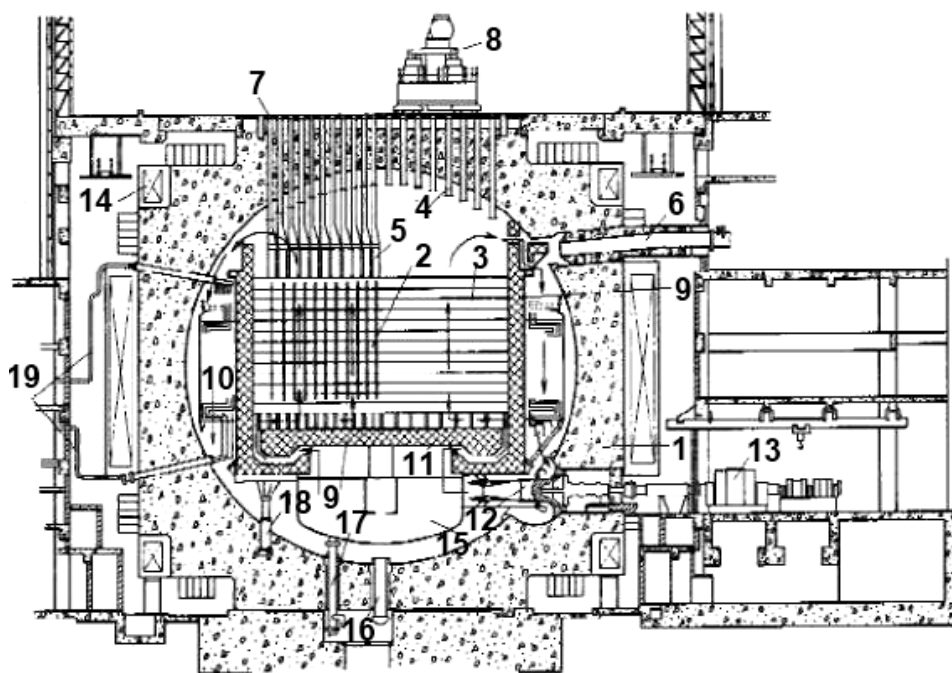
Поперечное сечение реактора «Магnox»: 1 – корпус реактора; 2 – ТВЭЛы; 3 – графитовый замедлитель; 4 – загрузочные каналы; 5 – система направляющих труб; 6 – каналы с предохранительными клапанами; 7 – крышка; 8 – загрузочная машина; 9 – нейтронная защита; 10 – парогенератор; 11 – радиальная решетка; 12 – газодувка; 13 – двигатель газодувки; 14 – струны, создающие предварительное напряжение бетона; 15 – нагнетательная камера; 16 – люк для доступа персонала; 17 – канал для  $\text{CO}_2$ ; 18 – опорные колонны; 19 – паропроводы и трубопроводы для питательной воды
